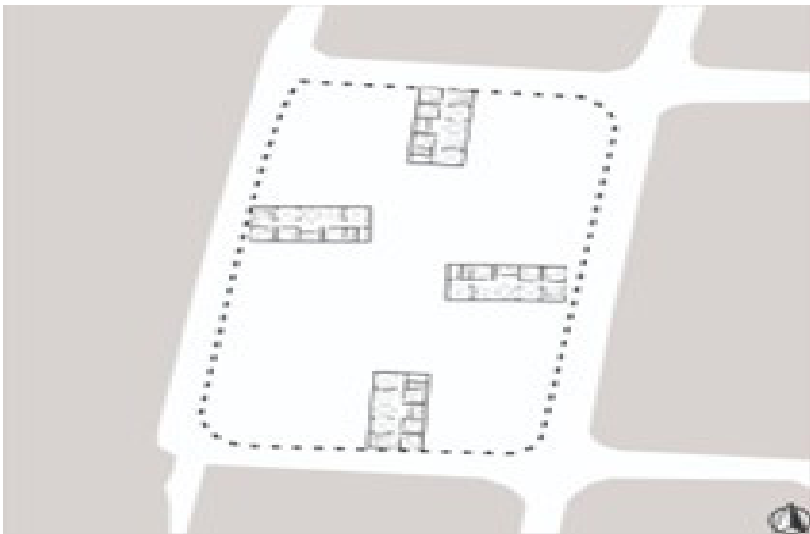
Planta arquitectónica y modelo de crecimiento de la casa tipo para hacer la evaluación bioclimática.
